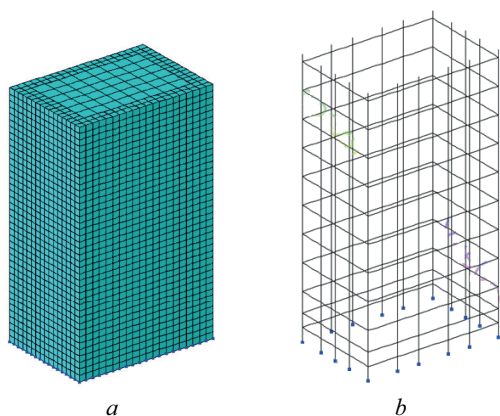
Общий вид (а) и схема армирования (б) расчетной модели столбчатого фундамента МНЛЗ
